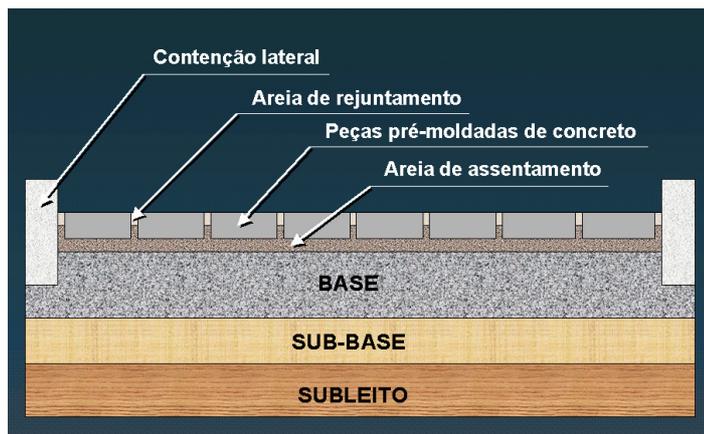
Exemplo de estrutura de pavimento de blocos intertravados de concreto
